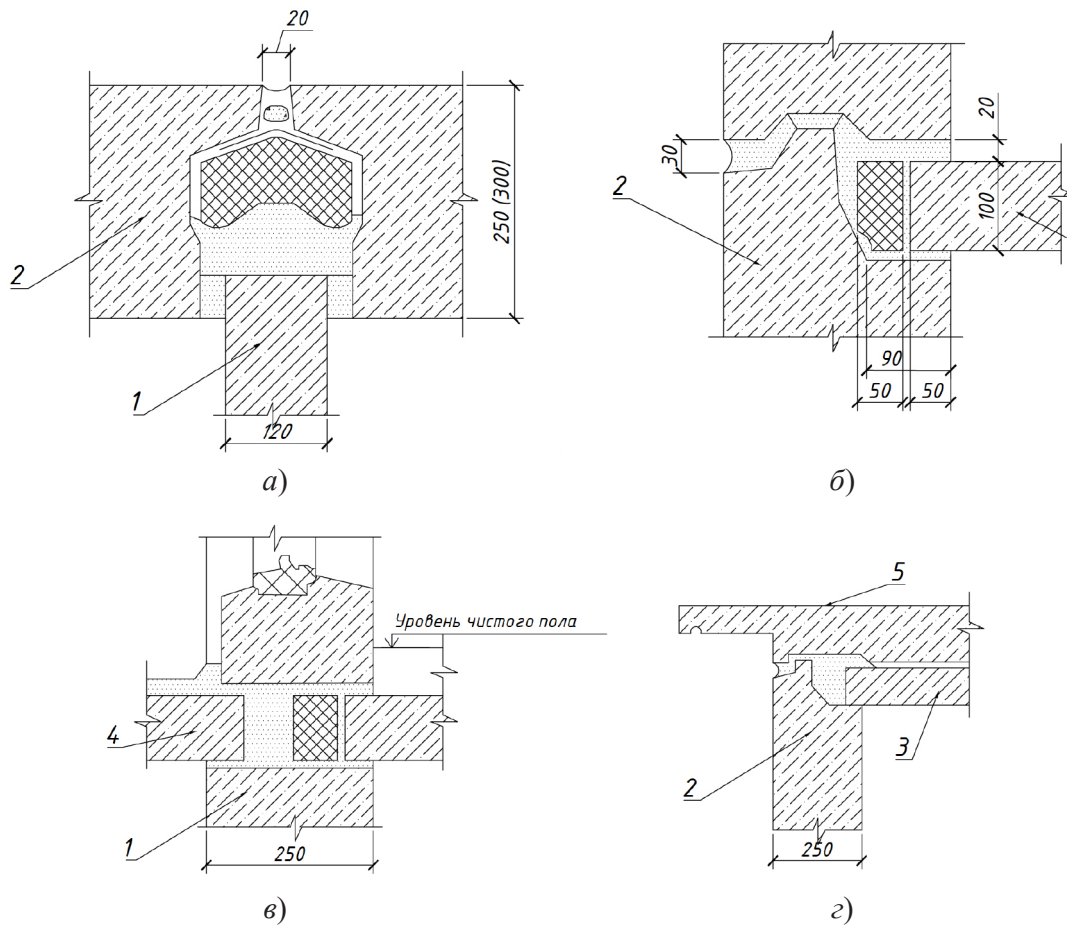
Стыки: а – вертикальный стык наружных стеновых панелей; б – горизонтальный стык наружных стеновых панелей; в – узел заделки балконной плиты; з – карнизный узел; 1 – внутренняя стеновая панель; 2 – наружная стеновая панель; 3 – плита перекрытия; 4 – балконная плита; 5 – плита покрытия с карнизным выпуском
